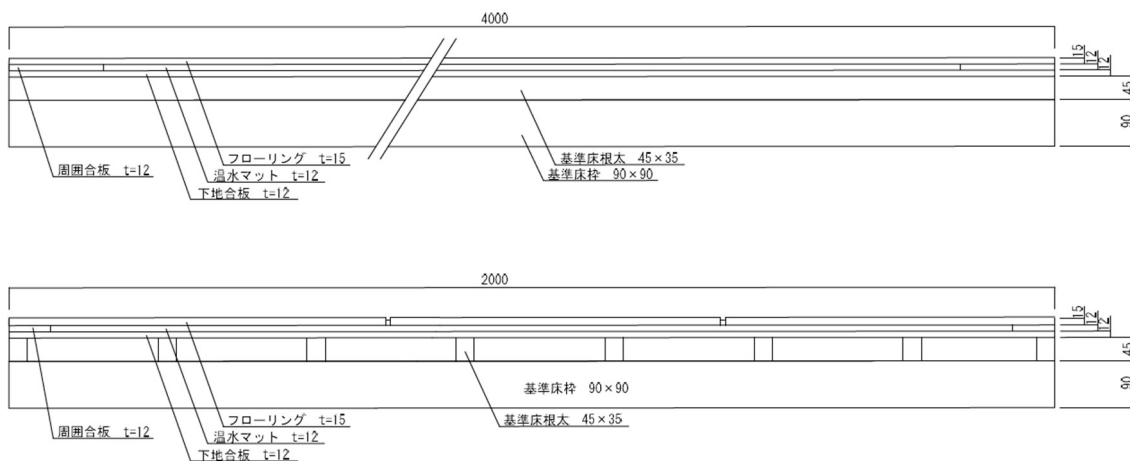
試験体図(試験体断面図、施工時に確認) 単位 : mm
